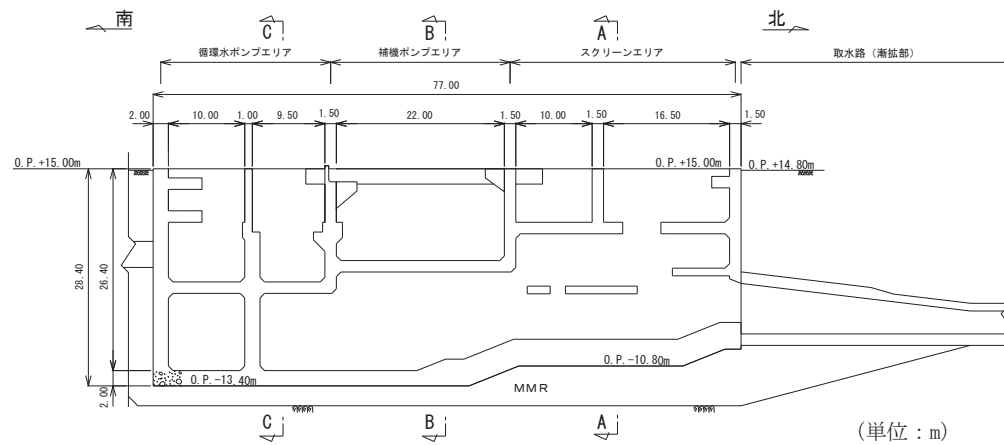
海水ポンプ室断面図 (E-E 断面, 南北)
